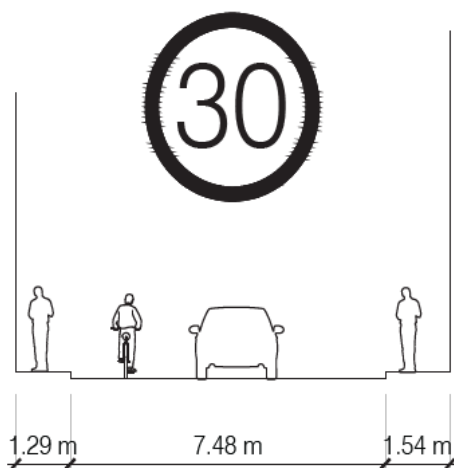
Sezione trasversale di progetto Strada Comunale Ottaviano
